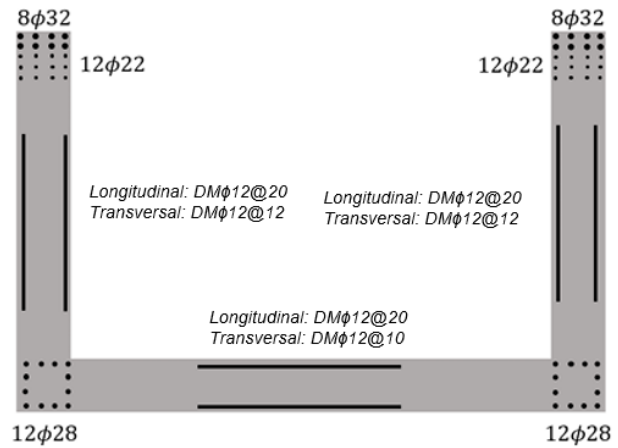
Refuerzo Muro C inferior MC1.(Cofré, 2020)
